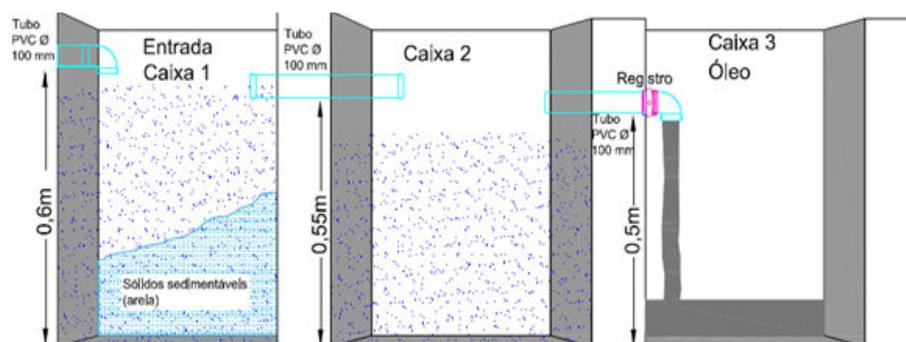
Corte Longitudinal de um Sistema Separador com Vista do Óleo
